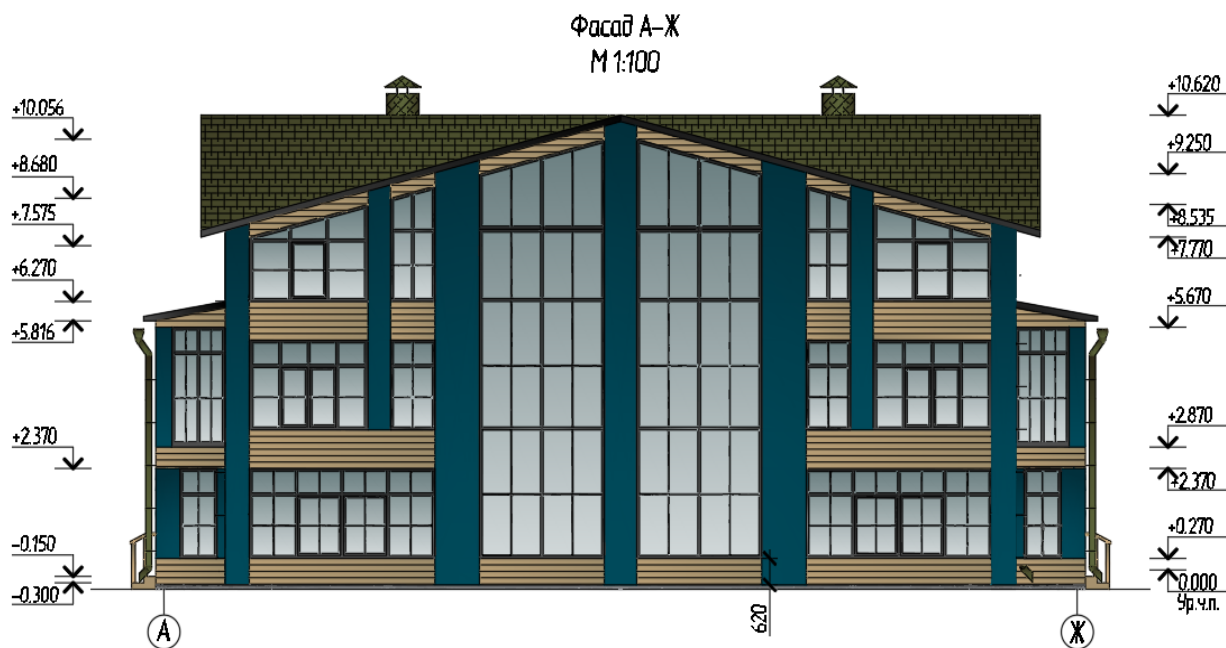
Фасад с дворовой части здания, М 1:100
